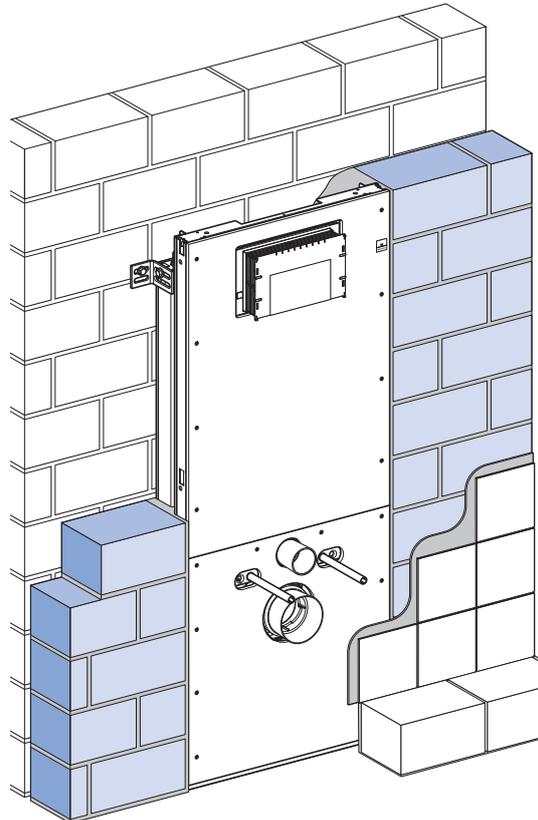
Geberit Duofix Element für Massivbau in einer gemauerten Wand
